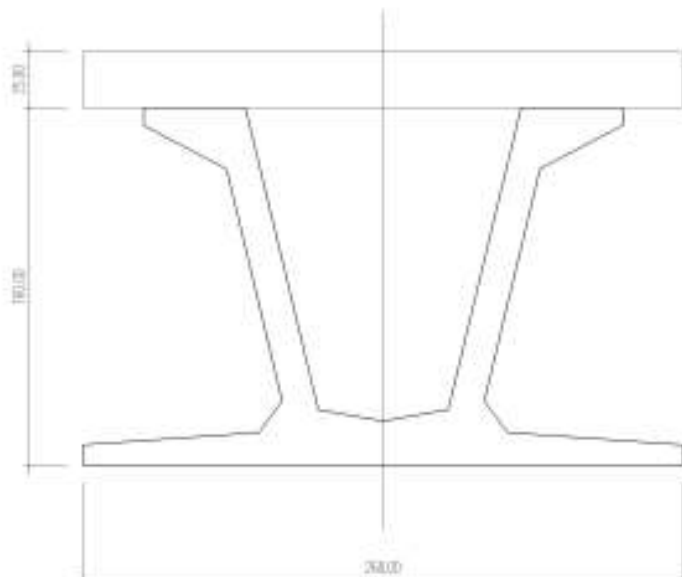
Sezione corrente della trave prefabbricata in c.a.p.
